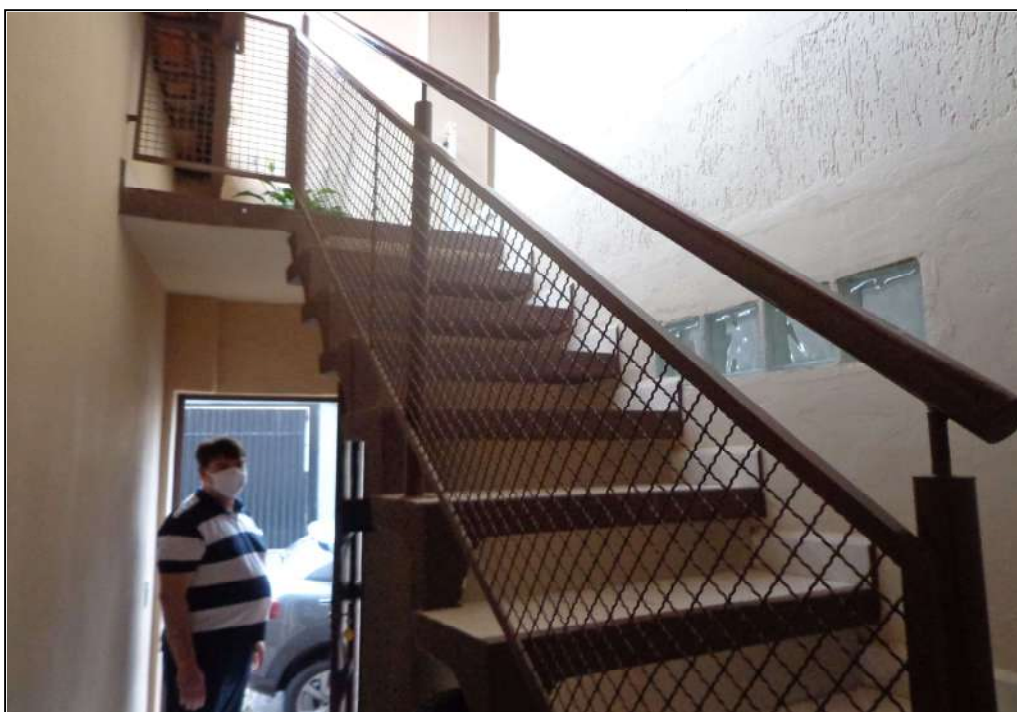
Vista interna do imóvel, onde visualizamos a escada interna de acesso entre o pavimento térreo (n.º 167) e o pavimento superior (n.º 167-A).
